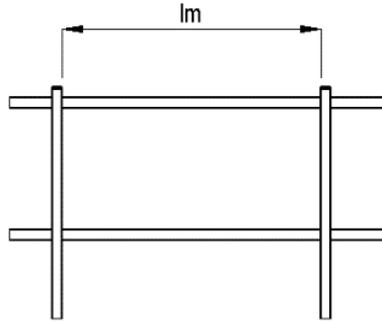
b – Componentes constructivos del parapeto autoportante inclinado.
